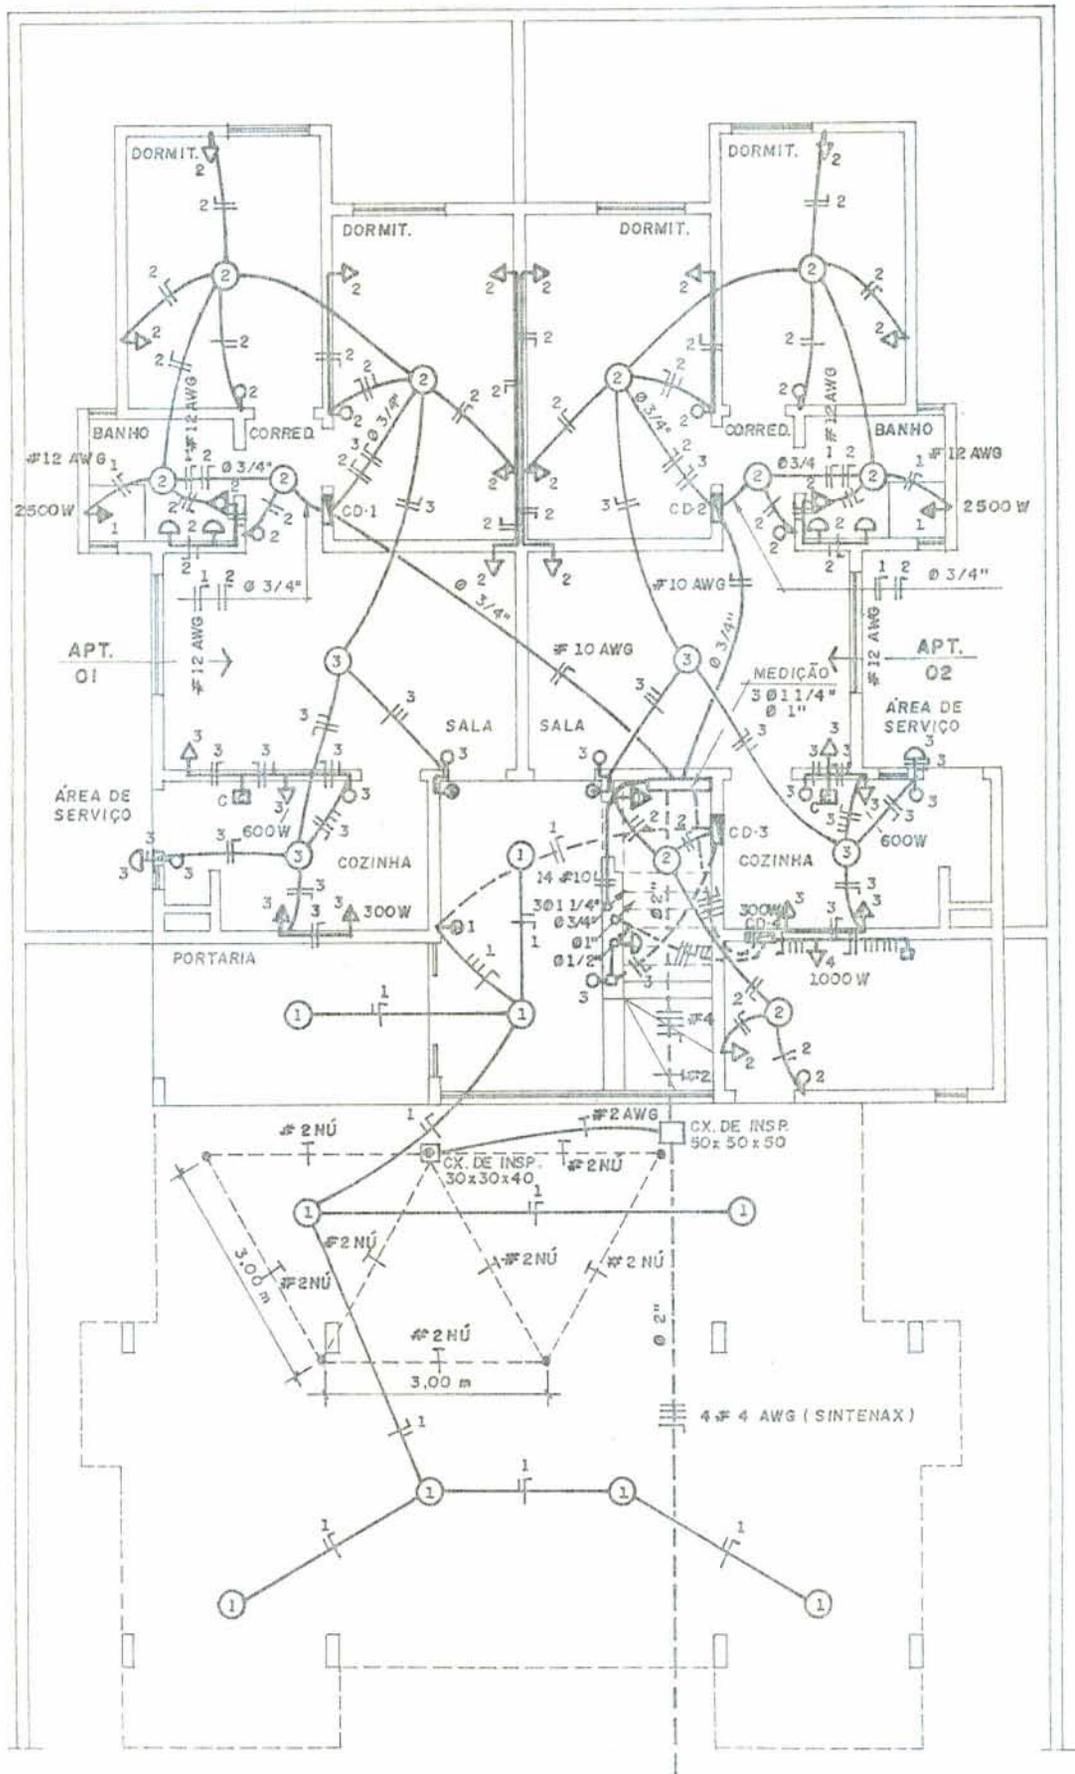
PLANTA DO PAVIMENTO TÉRREO - PROJETO DE INST. ELÉTRICA
